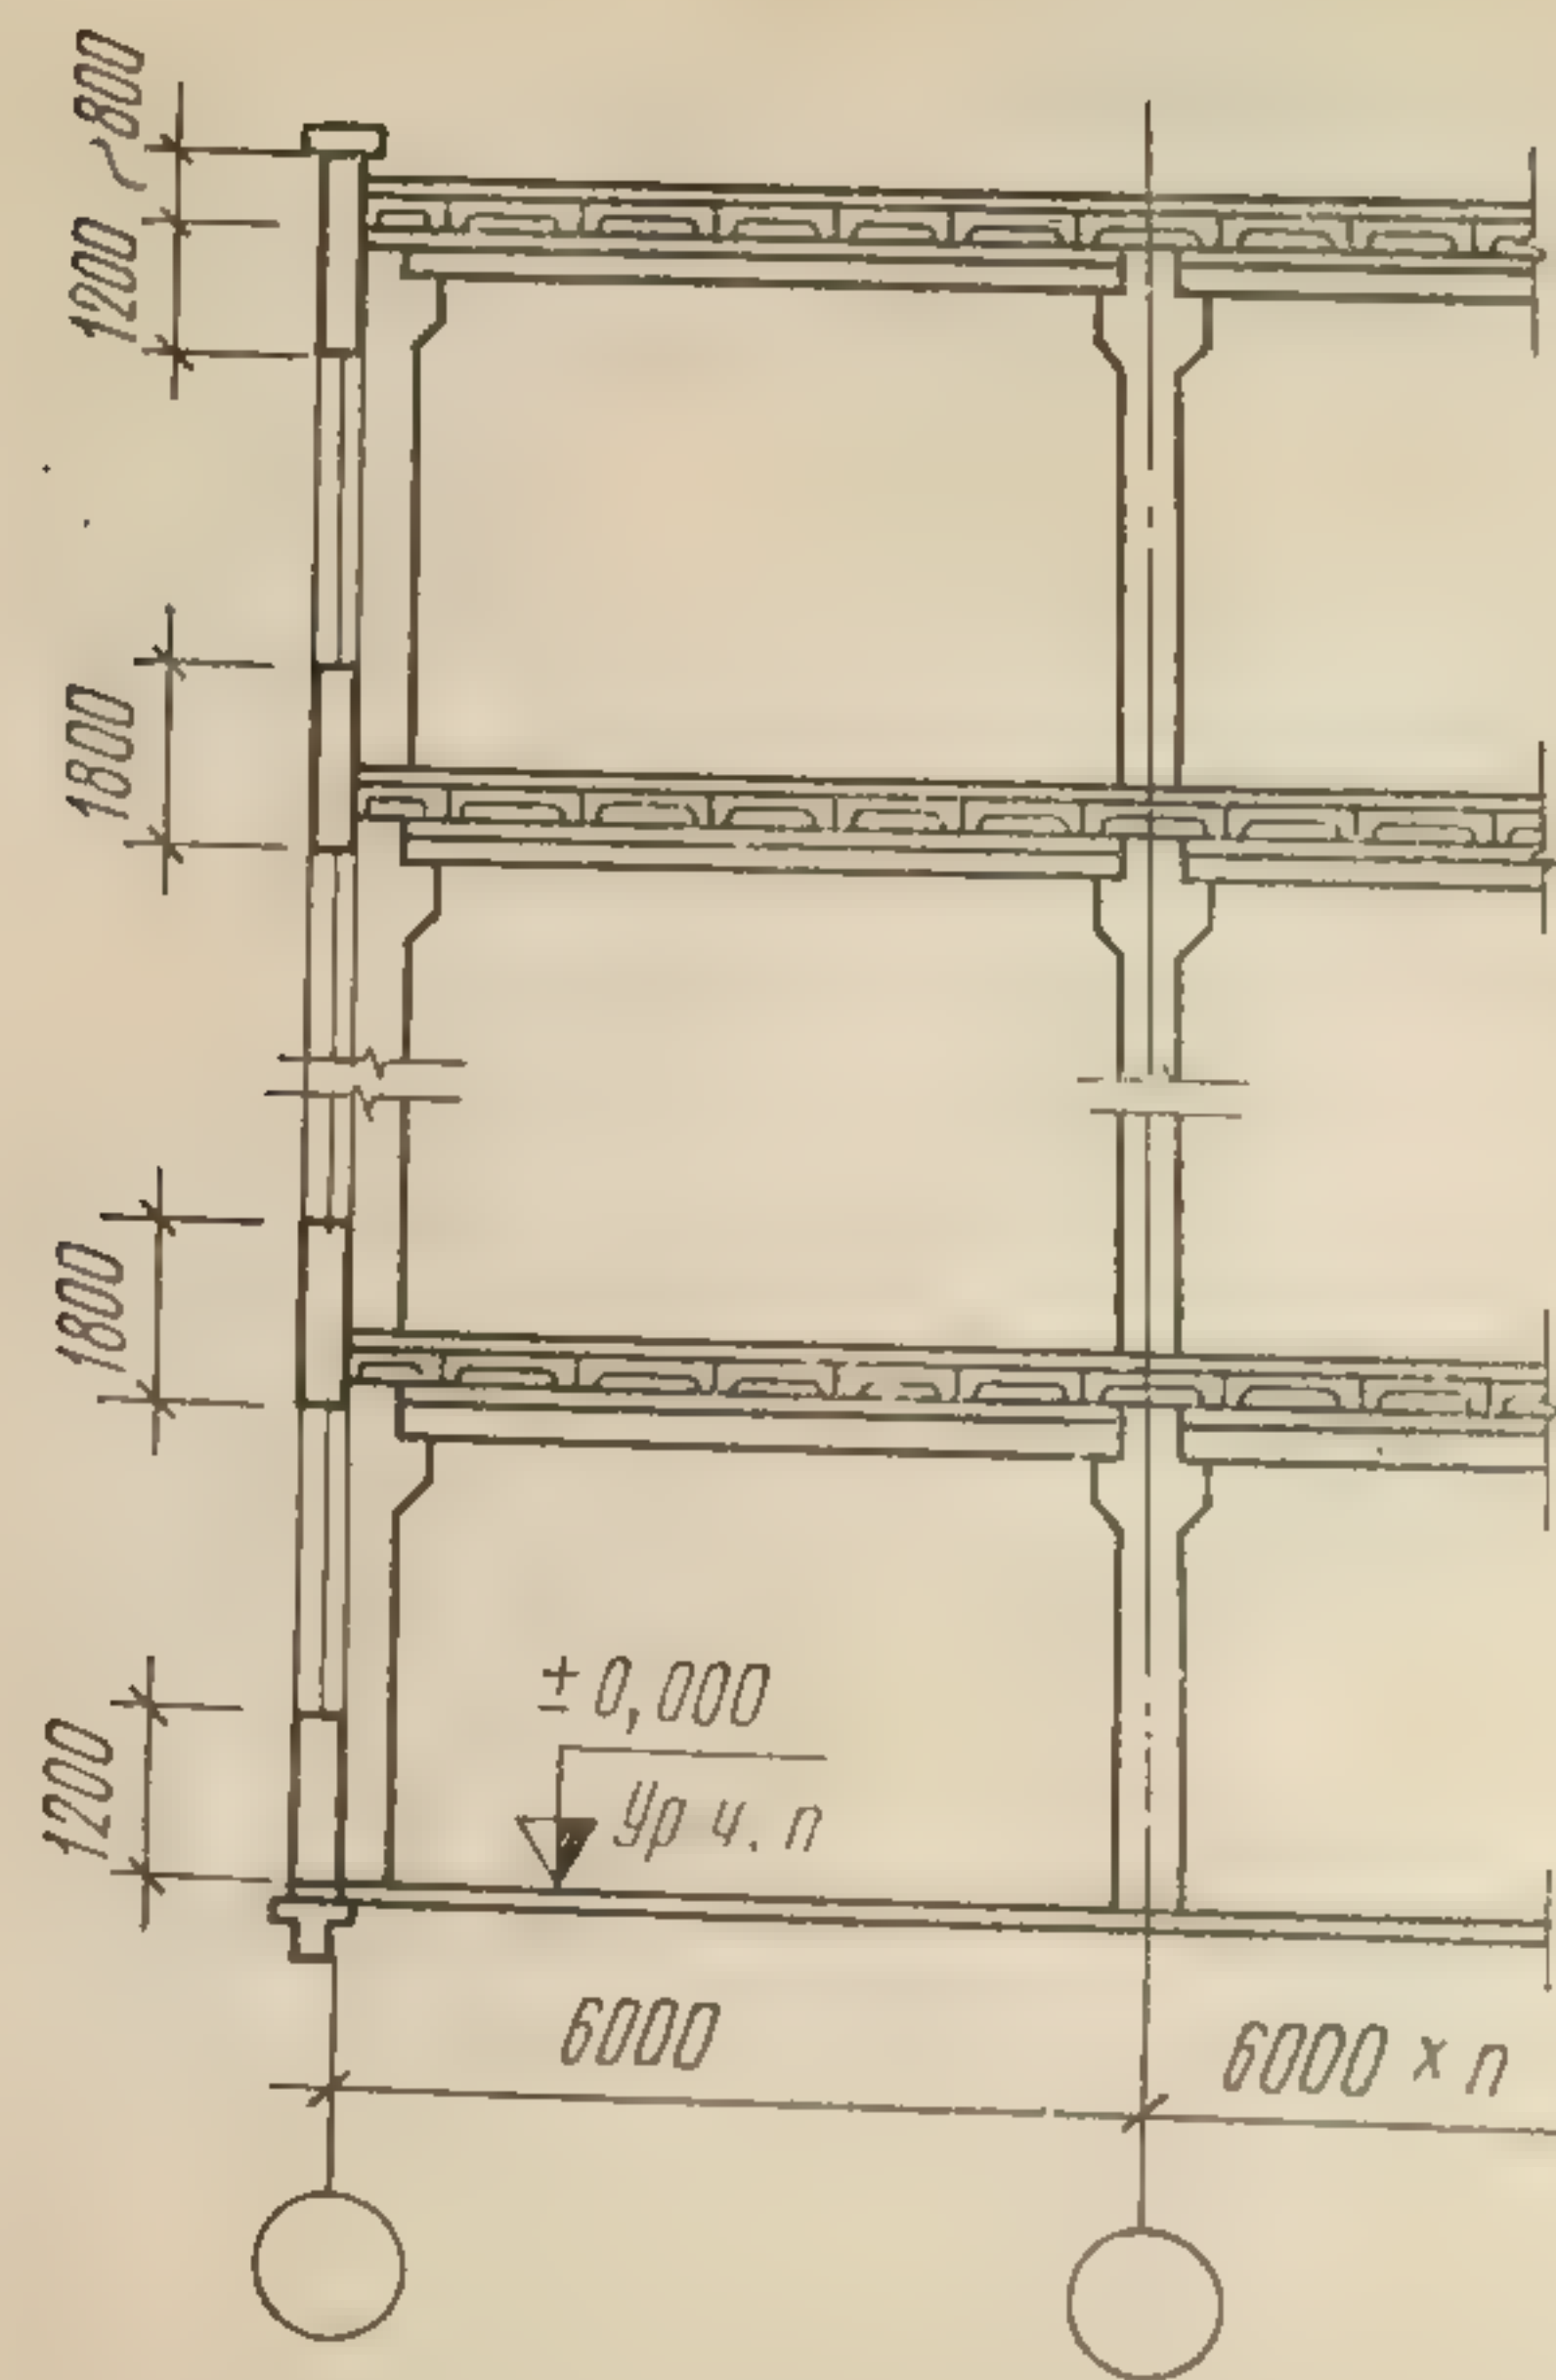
Многоэтажное здание с полным каркасом, самонесущими стенами и балочными перекрытиями с опиранием плит на боковые полки ригелей. Поперечный разрез
